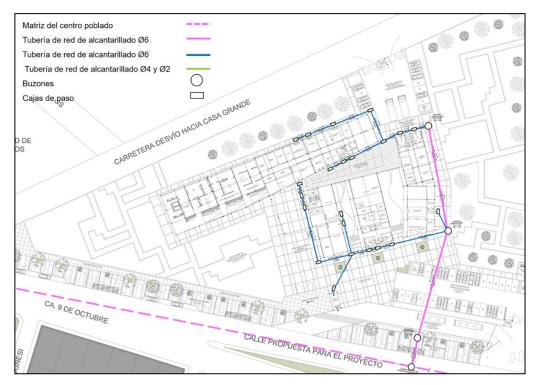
Planteamiento general de red de desagüe (alcantarillado sanitario)
